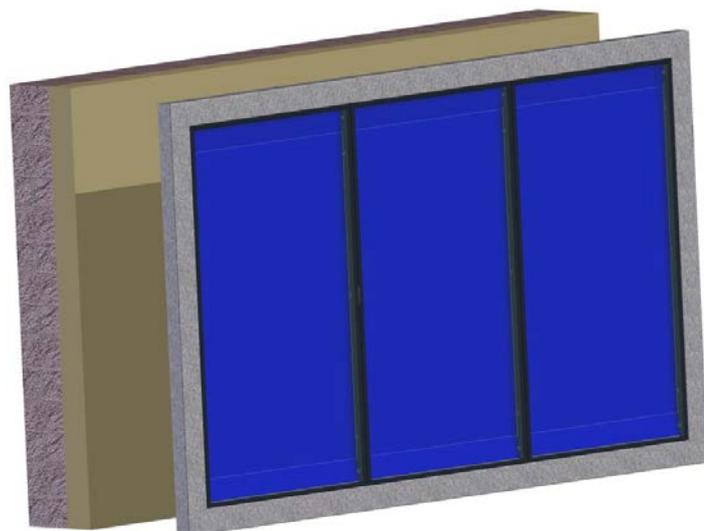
Modell des fassadenintegrierten Großflächenkollektors
